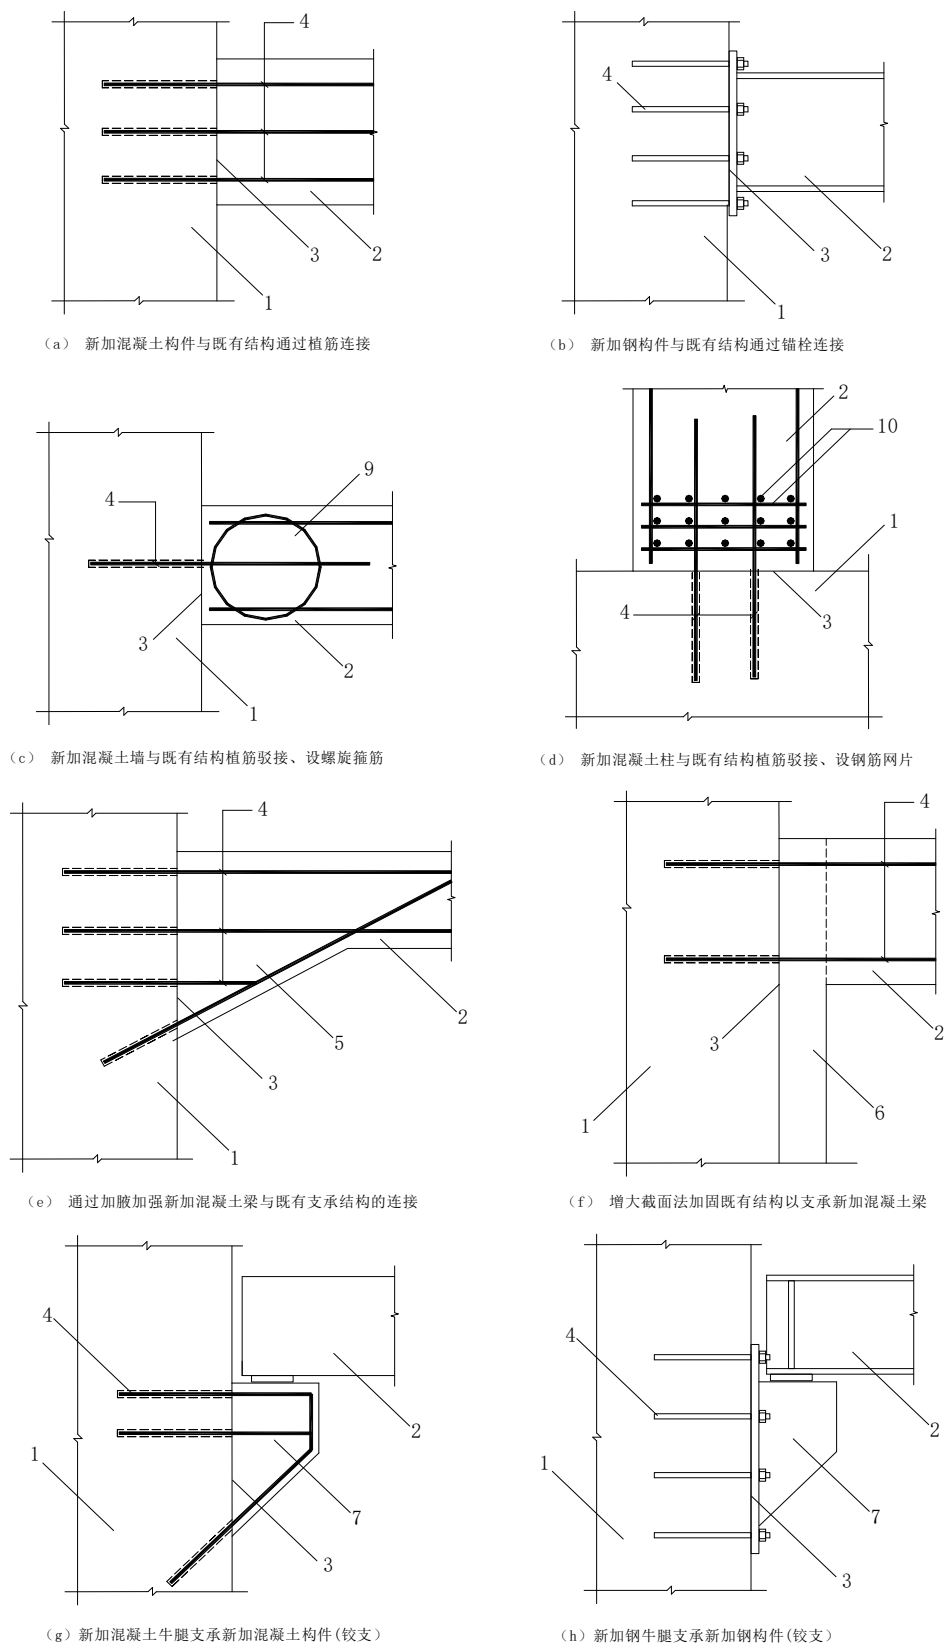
新加结构构件与既有混凝土结构的连接方法
